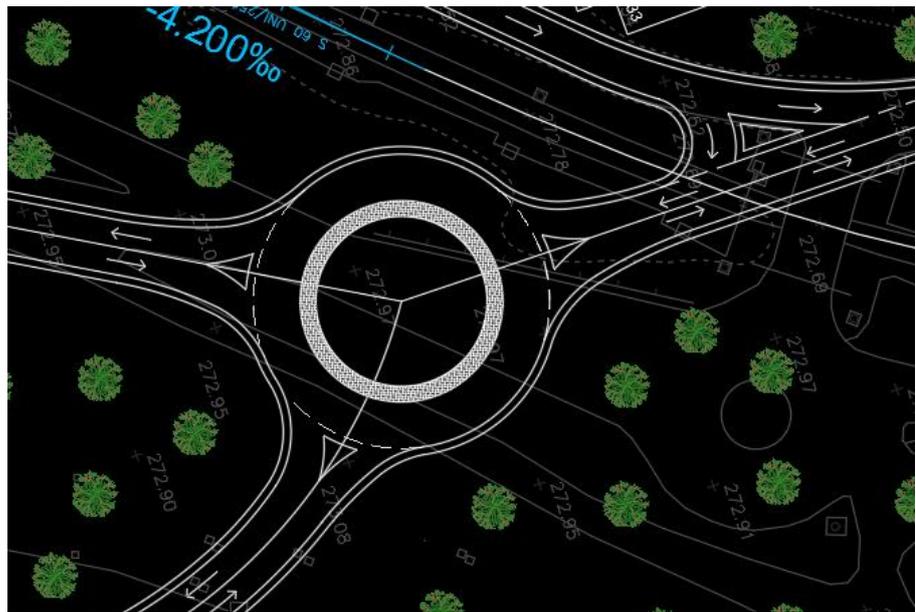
Estratto Autocad della rotondella posizionata agli ingressi dell'AFA
